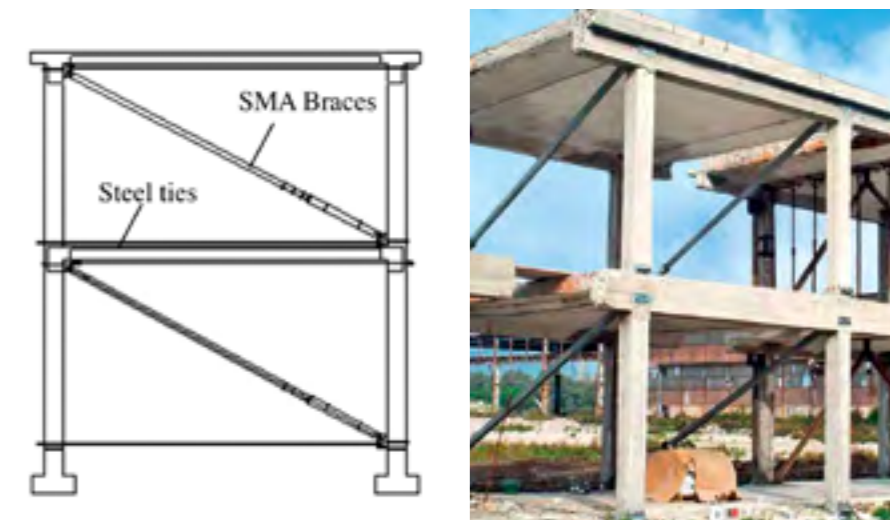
Struttura dell'edificio di prova e vista del telaio trasversale rinforzato con i controventi dissipativi basati sulle LMF (Progetto ILVA-IDEM).
